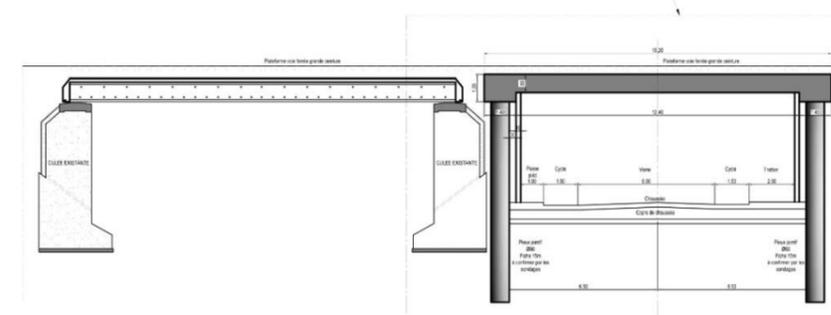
Modification de l'ouvrage sous la RD 190 (vue en coupe de l'ouvrage existant à gauche et de l'ouvrage en projet à droite)
